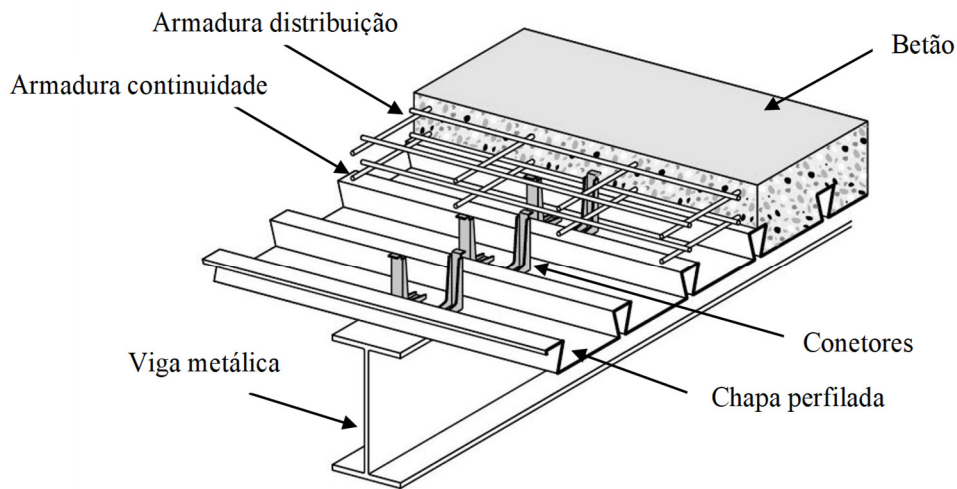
Pormenor tipo de uma laje mista (Fonte: Catálogo “O Feliz”)
